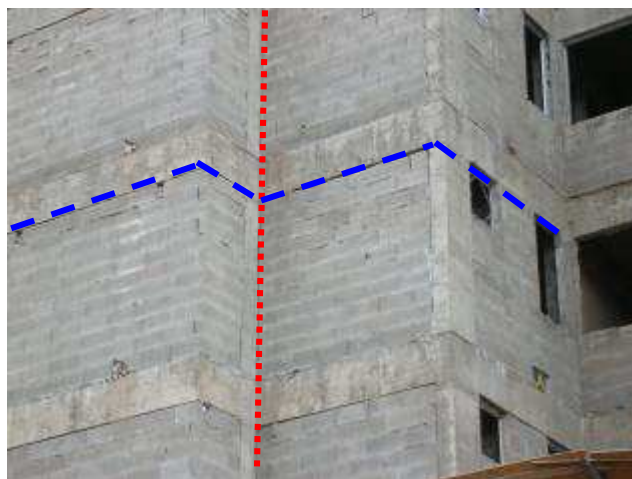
Juntas horizontais foram executadas no encontro viga/ alvenaria e terminam nas quinas das janelas e as juntas verticais foram executadas no encontro alvenaria/ pilar.
